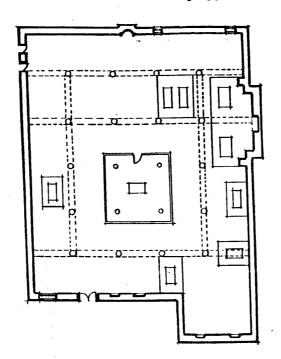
مسقط أفقى لجامع العريان بشارع العريان ١١٧١ ــ ١١٧٣ هـ / الكل (٢٨) مسقط أفقى لجامع أثر رقم ٢٠٠ (عن هيئة الآثار المصرية).
